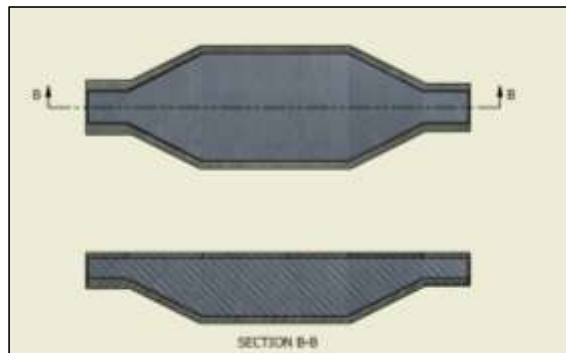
Esquema de desarenador vista en planta y lateral.
